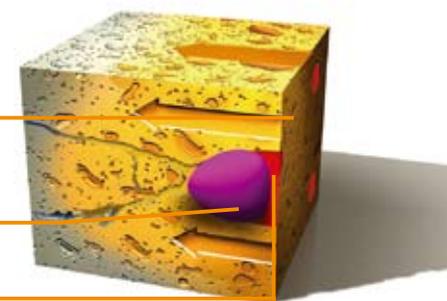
muestra un corte de grieta que ha sido sellado con Peneplug e impermeabilizado con Penetron®
